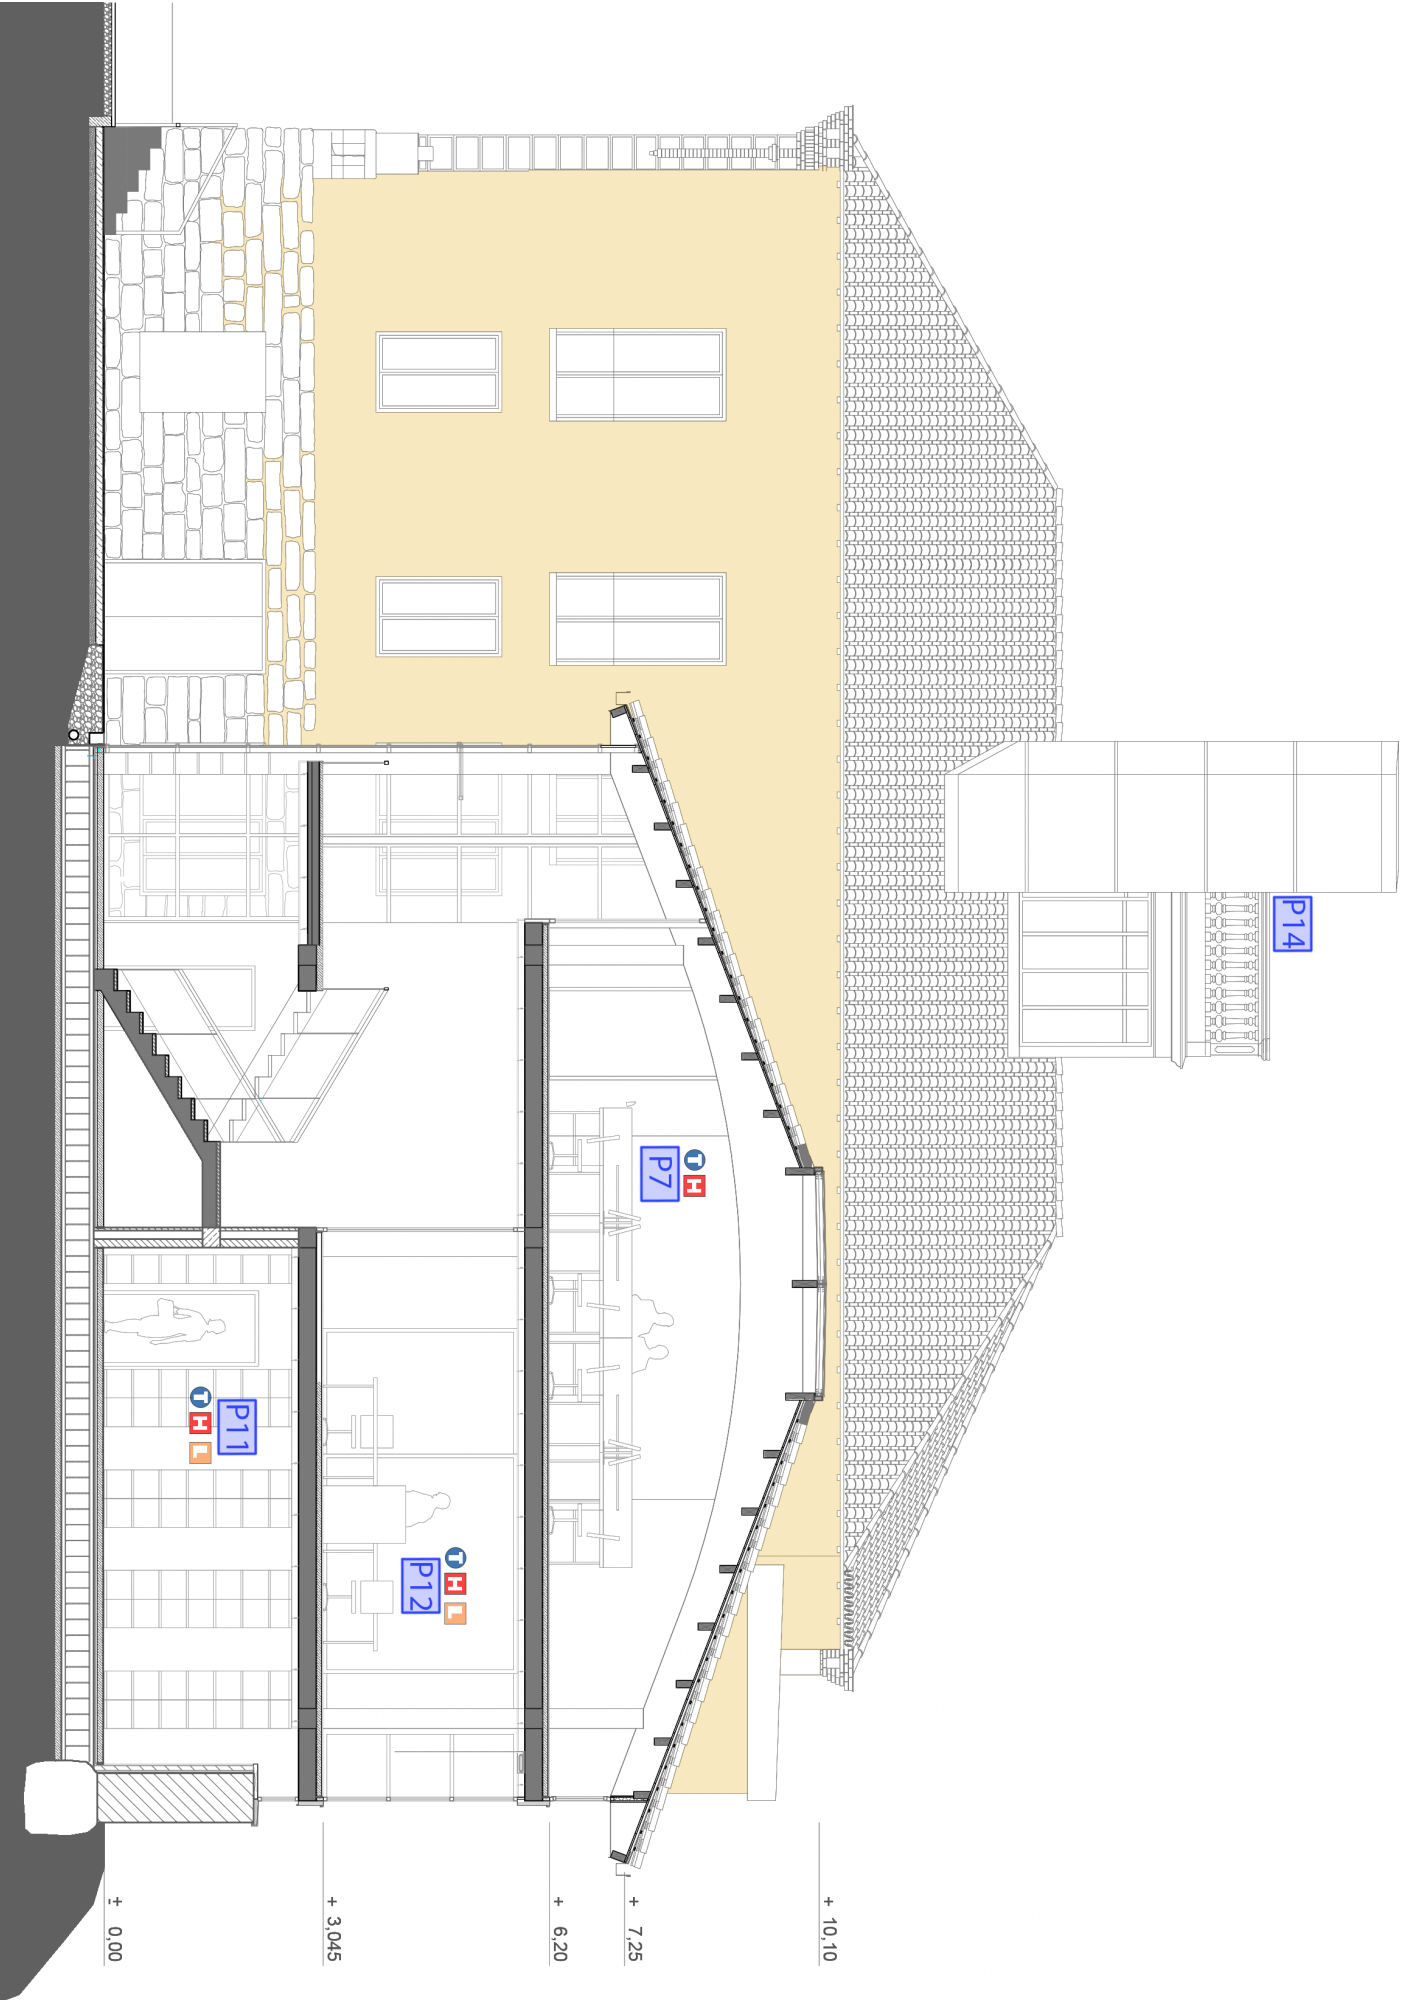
(Arriba).Sección longitudinal E 1:200. Fig 75 (Abajo) Ubicación de los sensores. Planta bajocubierta E 1:200
